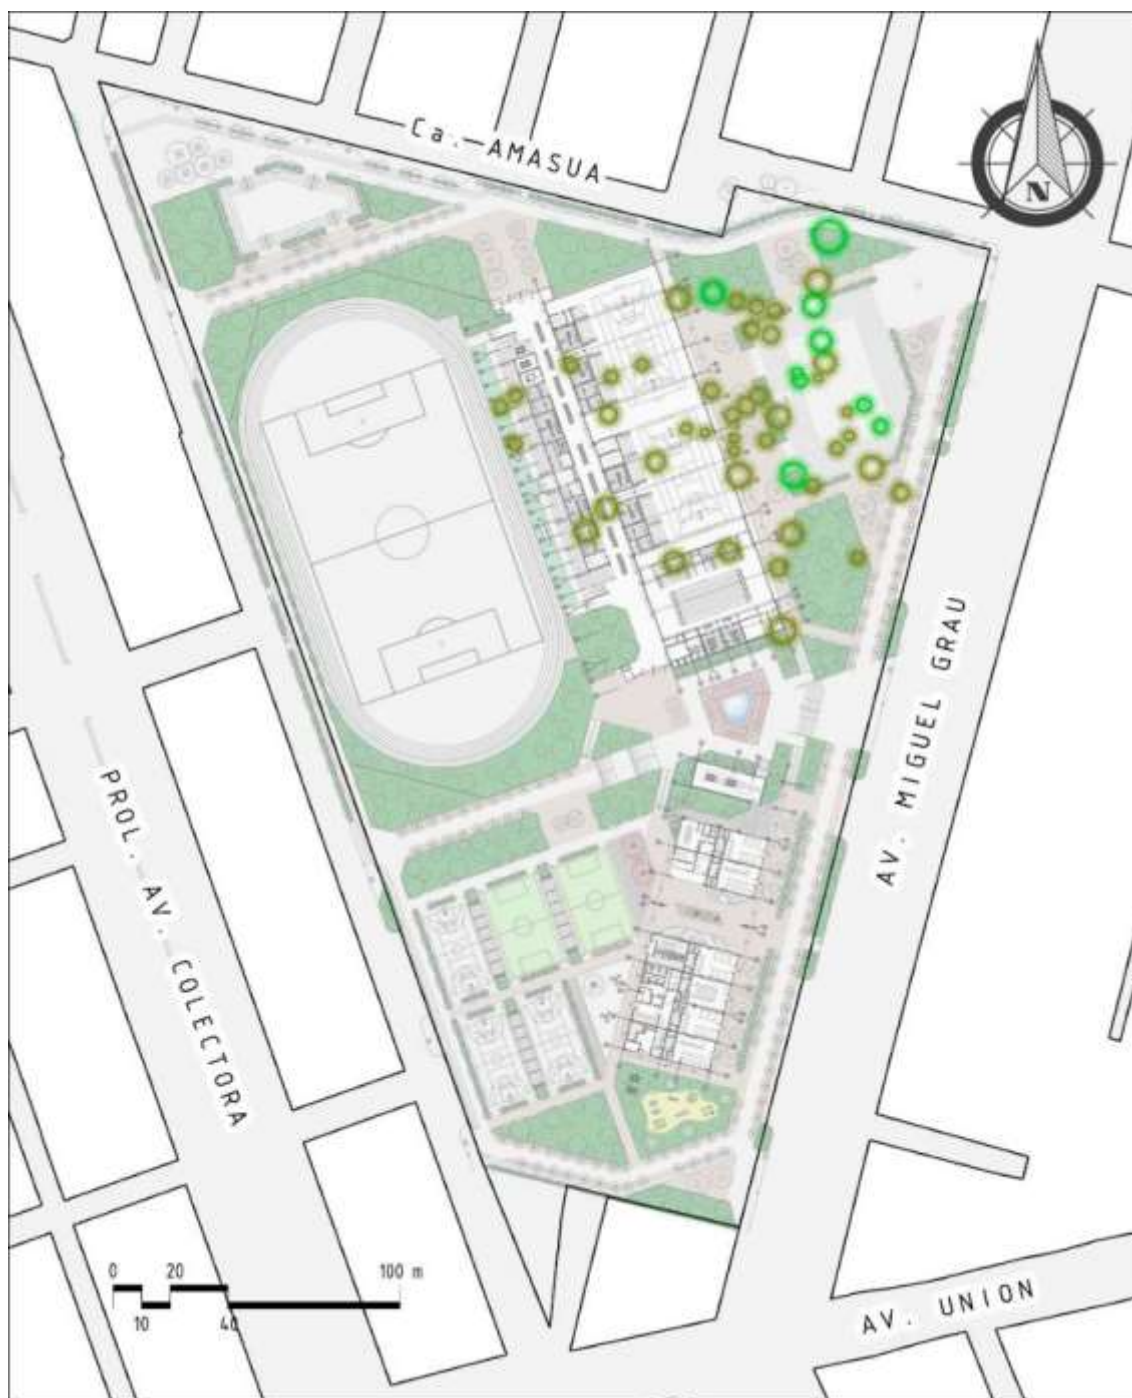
Vegetación Existente sobre la Propuesta
